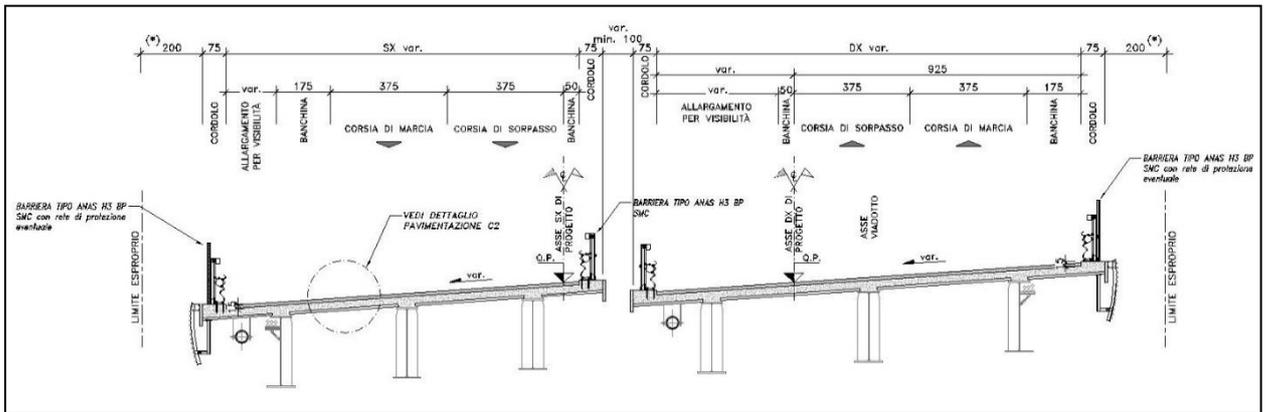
Sezione tipo B con una carreggiata in viadotto.
